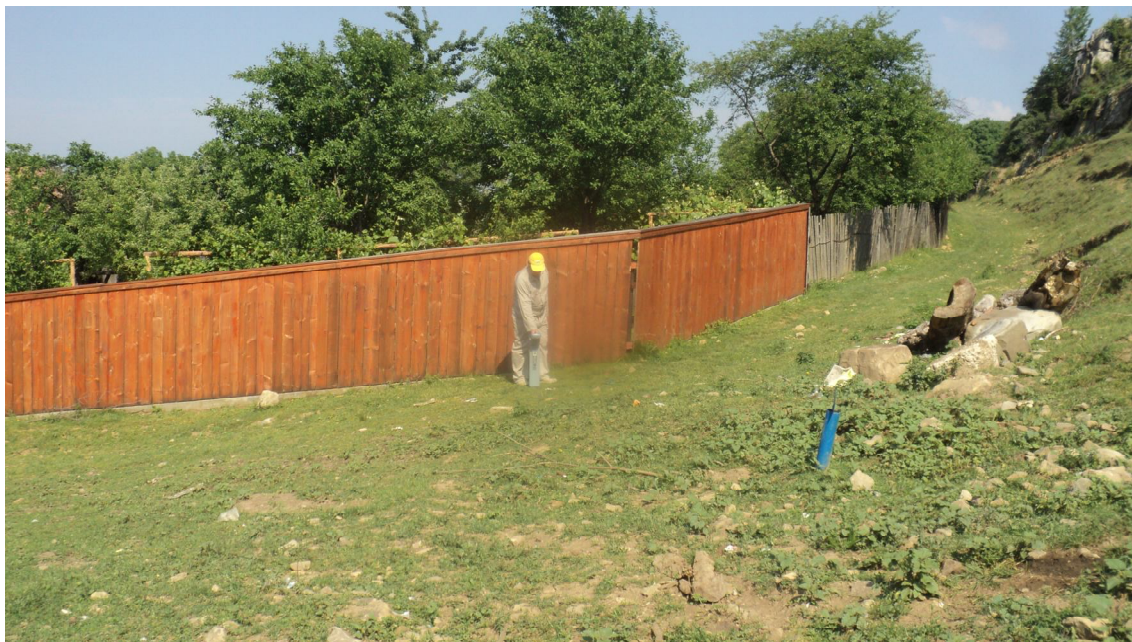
zona pichet 2 la iesire din proprietati particulare
